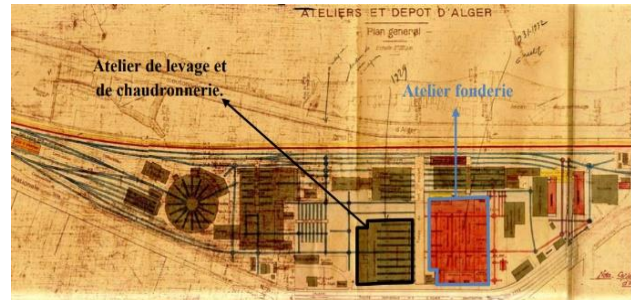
Plan du site 'ateliers S.N.T.F' 1926-1932. (Source : Archives SNTF).
